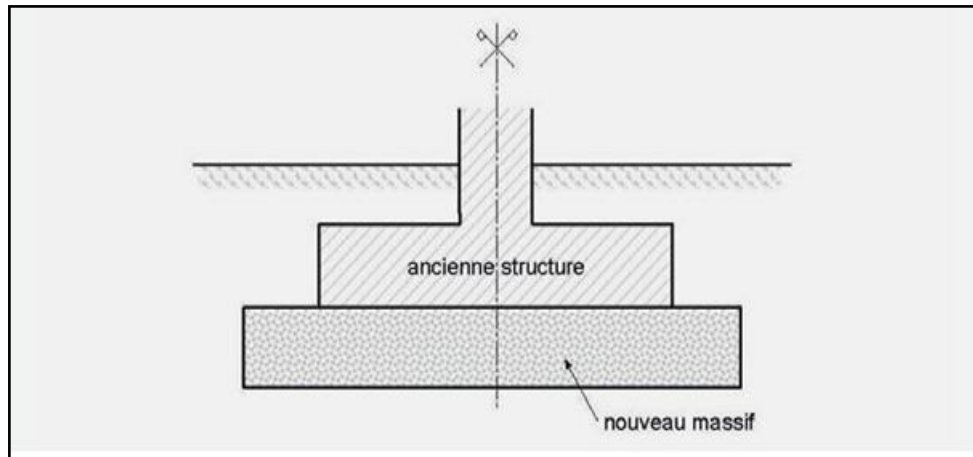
Renforcement de fondation à un niveau inférieur au niveau d'origine
